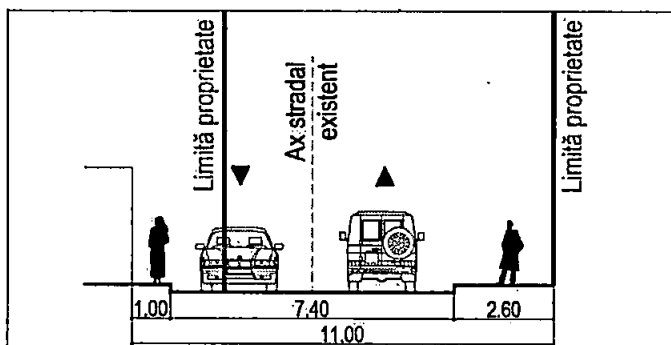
Profil stradal Aleea Daliei (zonă de acces din sud către terenul inițiator P.U.Z.)
